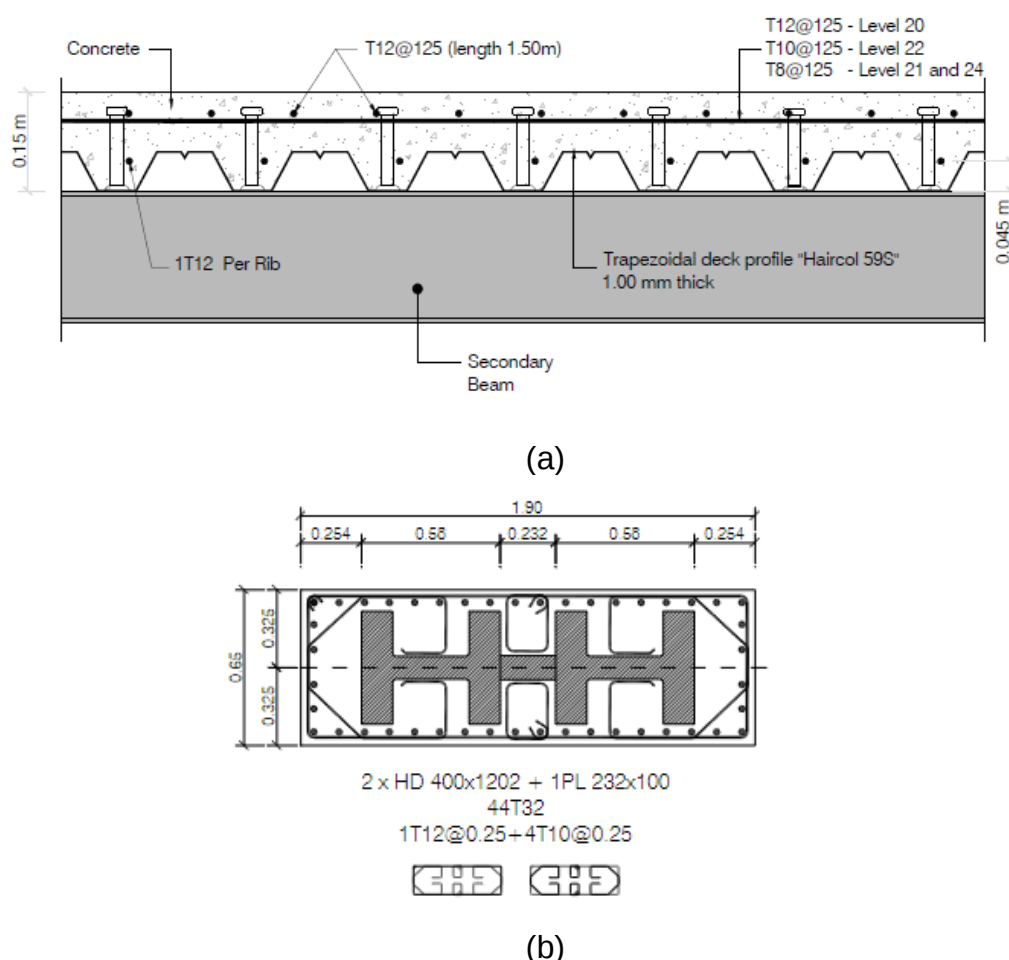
(a) secção transversal de uma parte da laje da EB e (b) secção transversal de uma coluna
